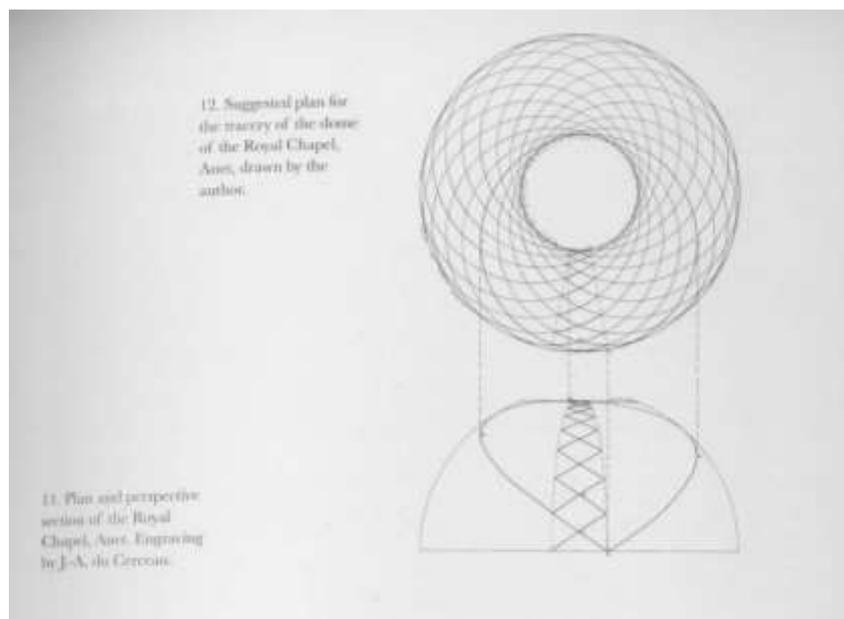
Reconstruction proposée par R. Evans de la construction géométrique reliant le sol et le dôme de la chapelle d'Anet R. EVANS, *Translations from drawing to building and other essays*, p.176/177
